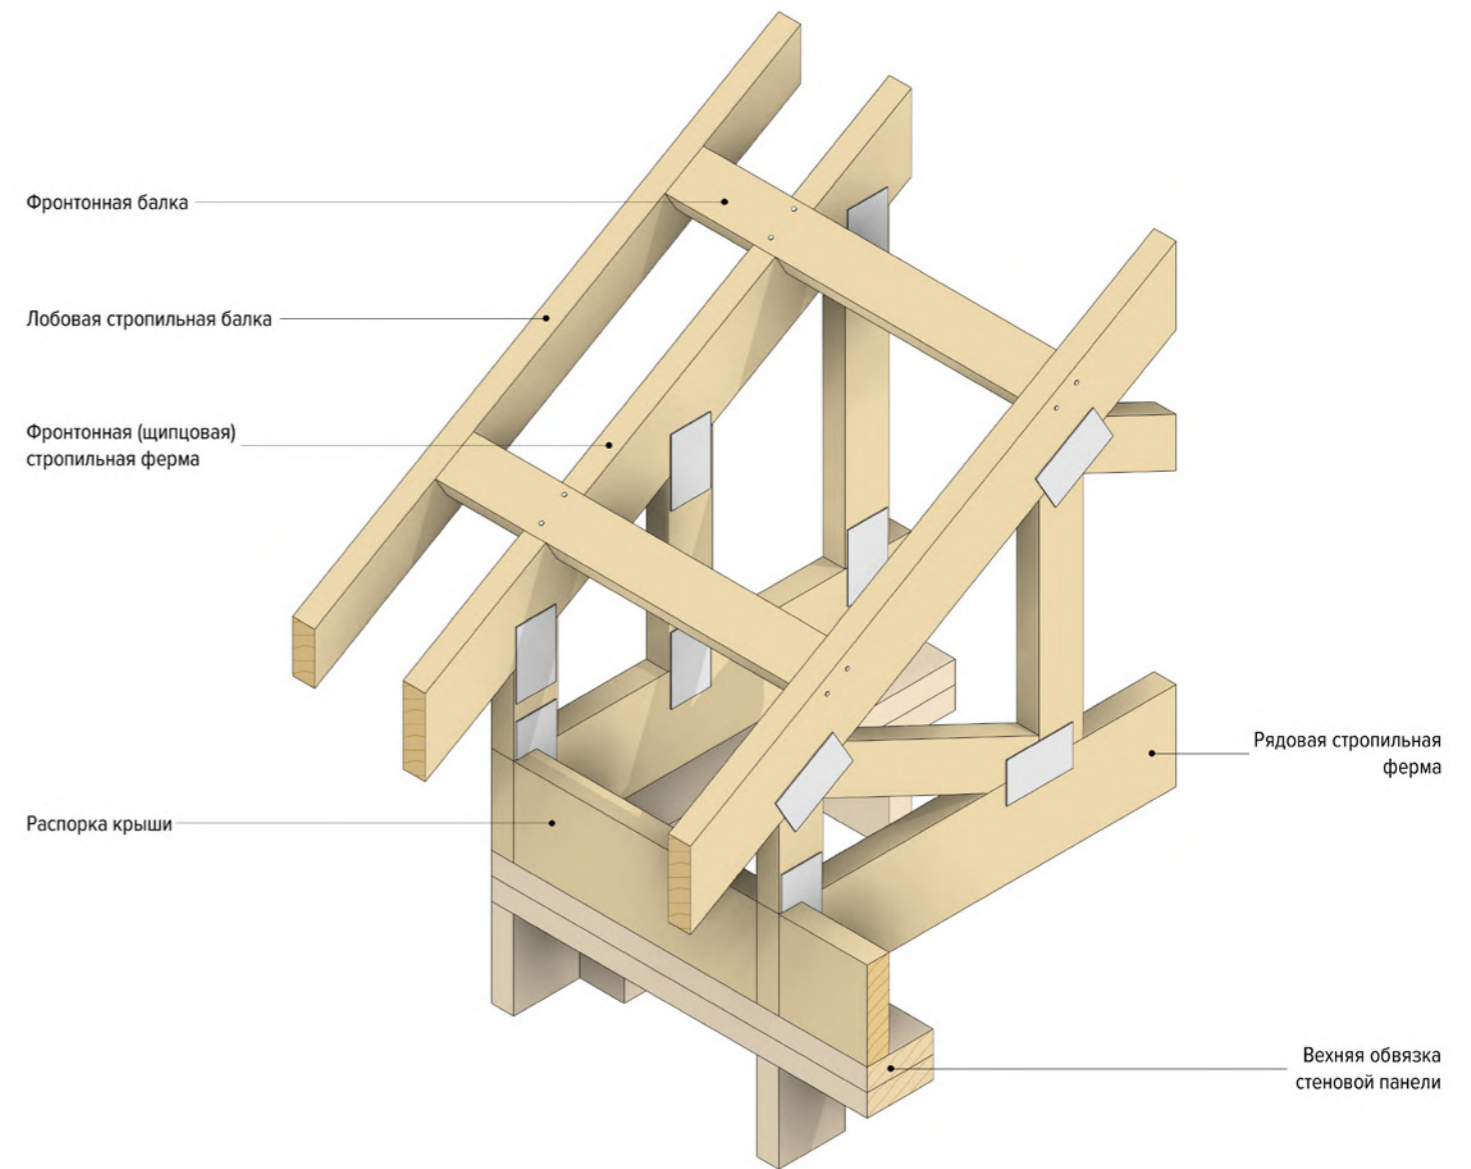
Основные конструктивные элементы каркаса скатной неутепленной крыши с применением стропильных ферм
